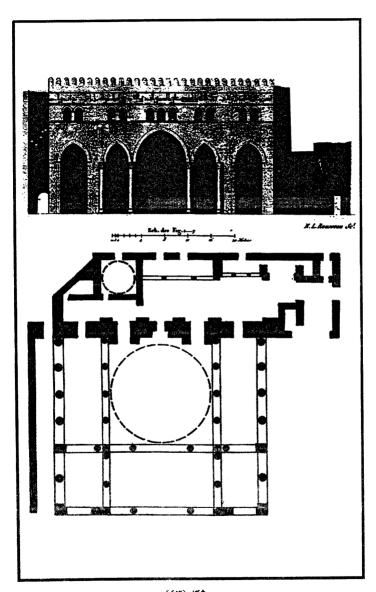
مسقط أفقى لردهة الباب الوسطاني عن مركز تسجيل الأثار
